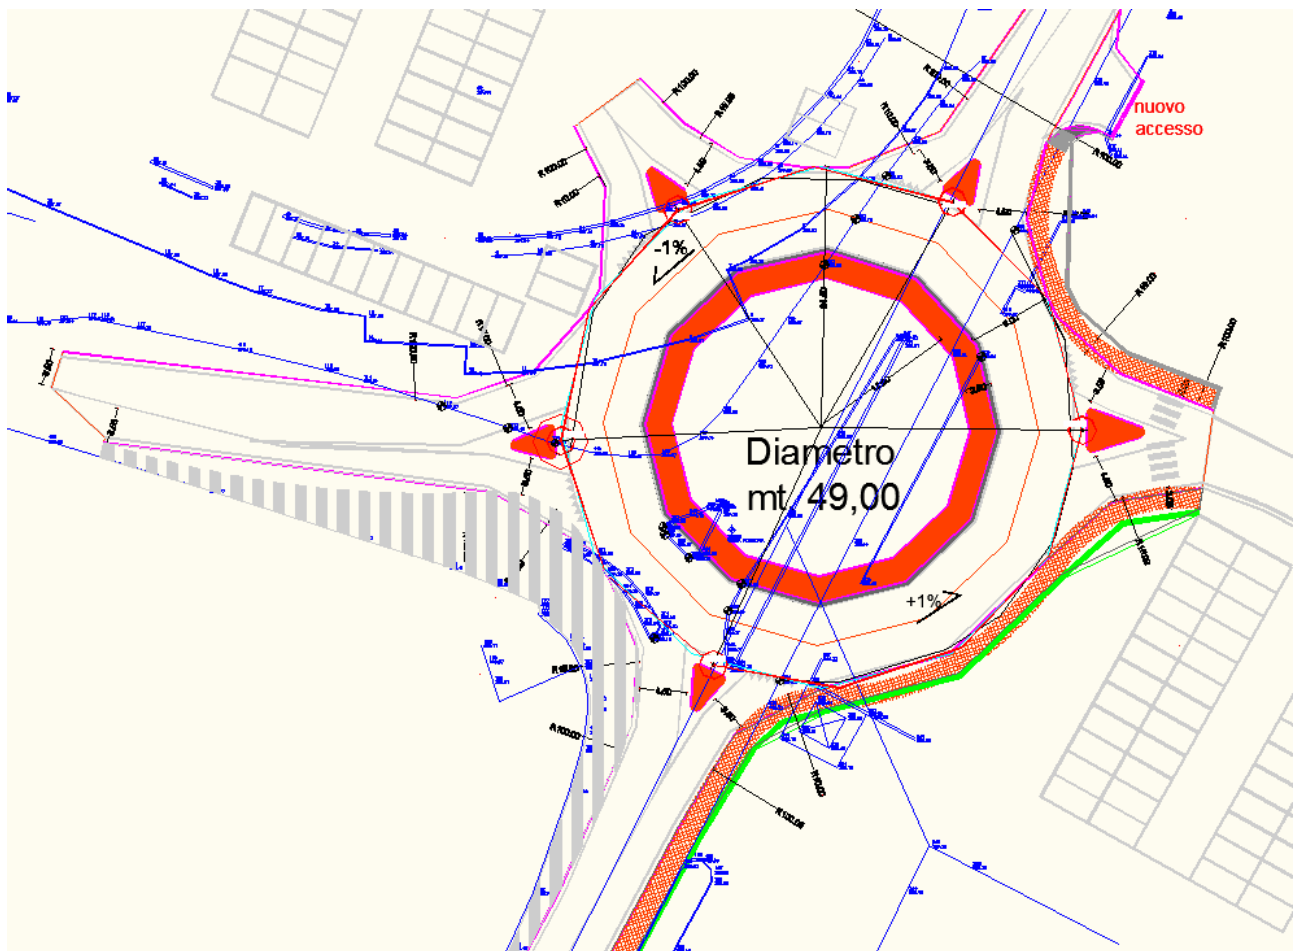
Planimetria di progetto – dettaglio anello rotatoria
